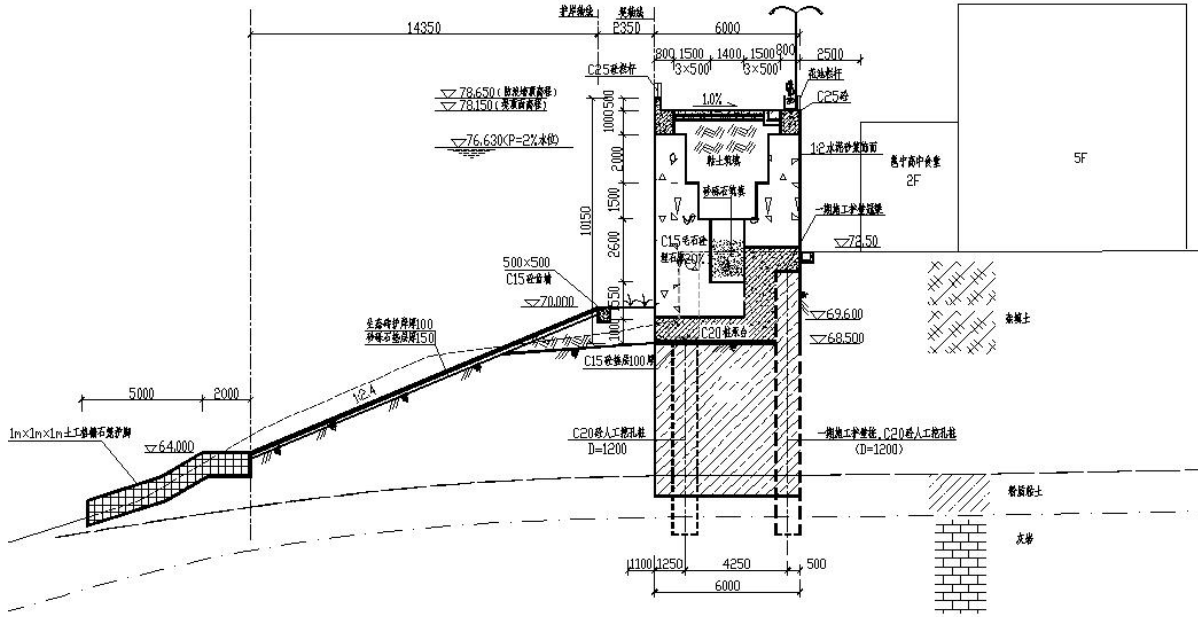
土石混合堤代表横剖面图 2（离建筑物较近堤段）
